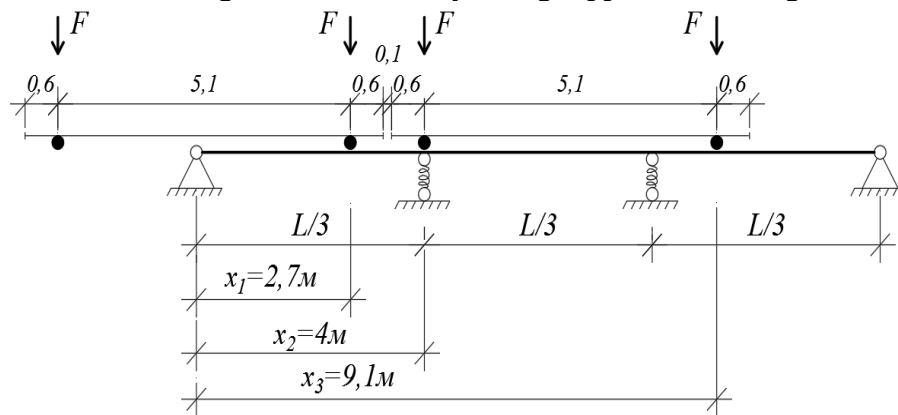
Нагрузки подкрановой балки с упруго- податливыми опорами по второму варианту
